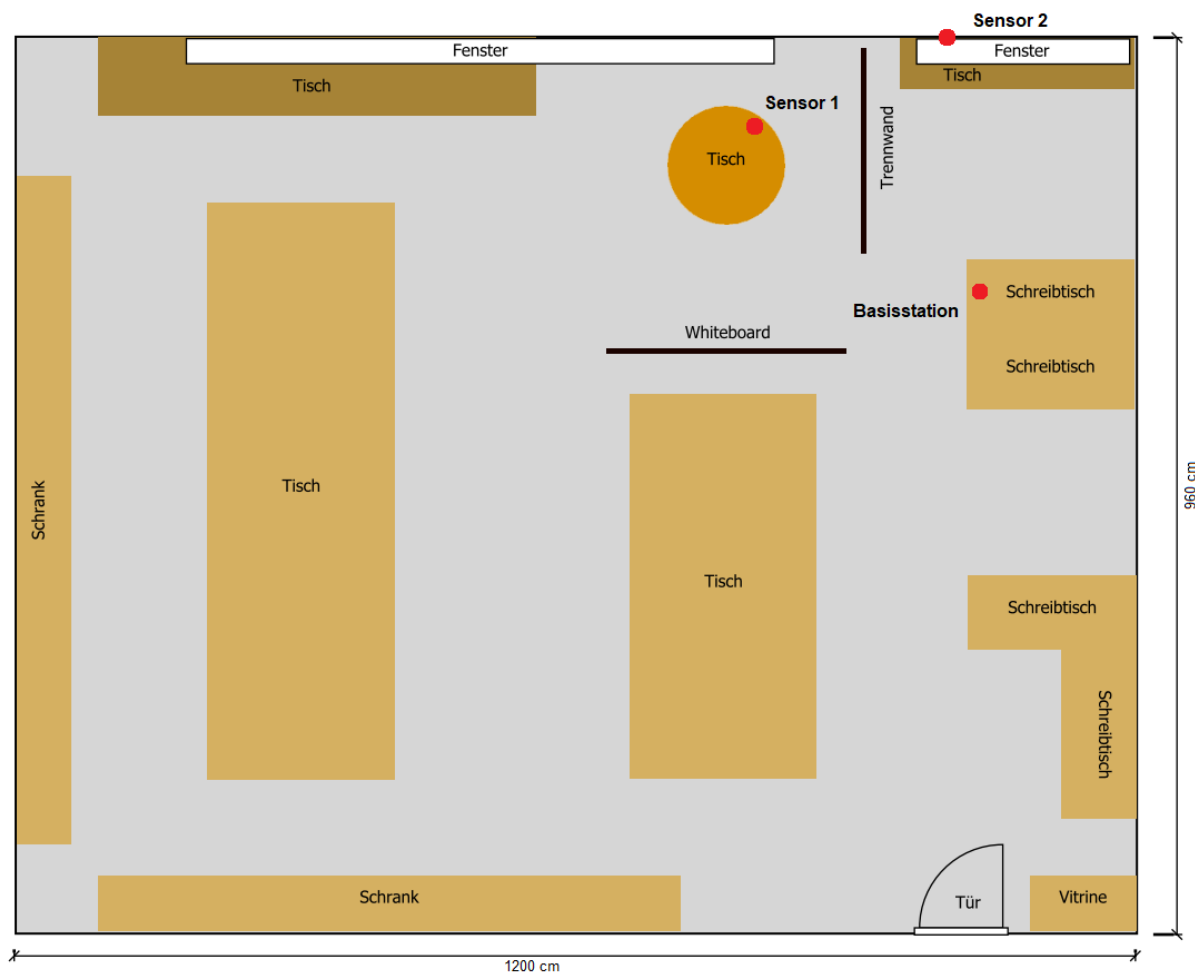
Grundriss des Raumes B101 mit Standorten der Geräte
